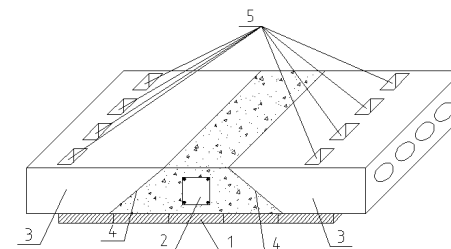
Способ устройства сборно – монолитного железобетонного перекрытия: 1 – опалубка; 2 – арматурный каркас ригеля; 3 – сборные многопустотные плиты; 4 – скошенные стороны плит; 5 – отверстия для ограничителей бетона
